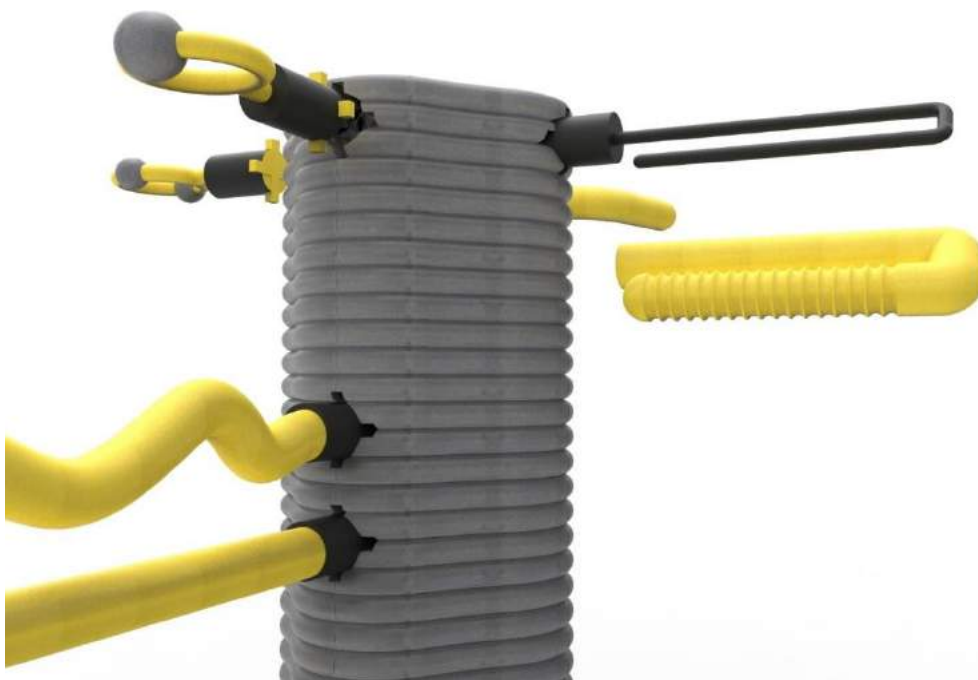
Detalle estructura soporte apoyo. Fuente: Elaboración propia.
